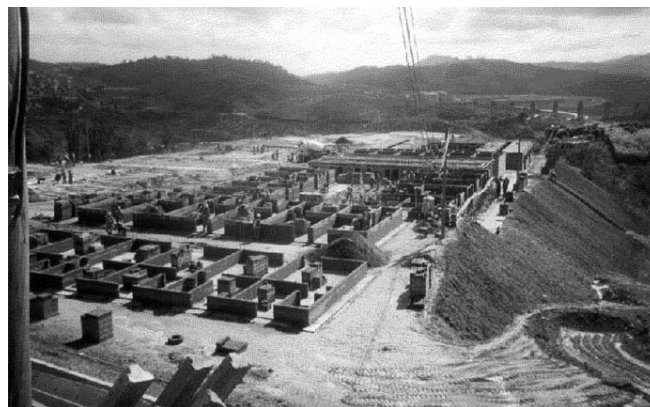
Aspectos gerais do canteiro de obras.. Foto: Wander Brás, 2001.
